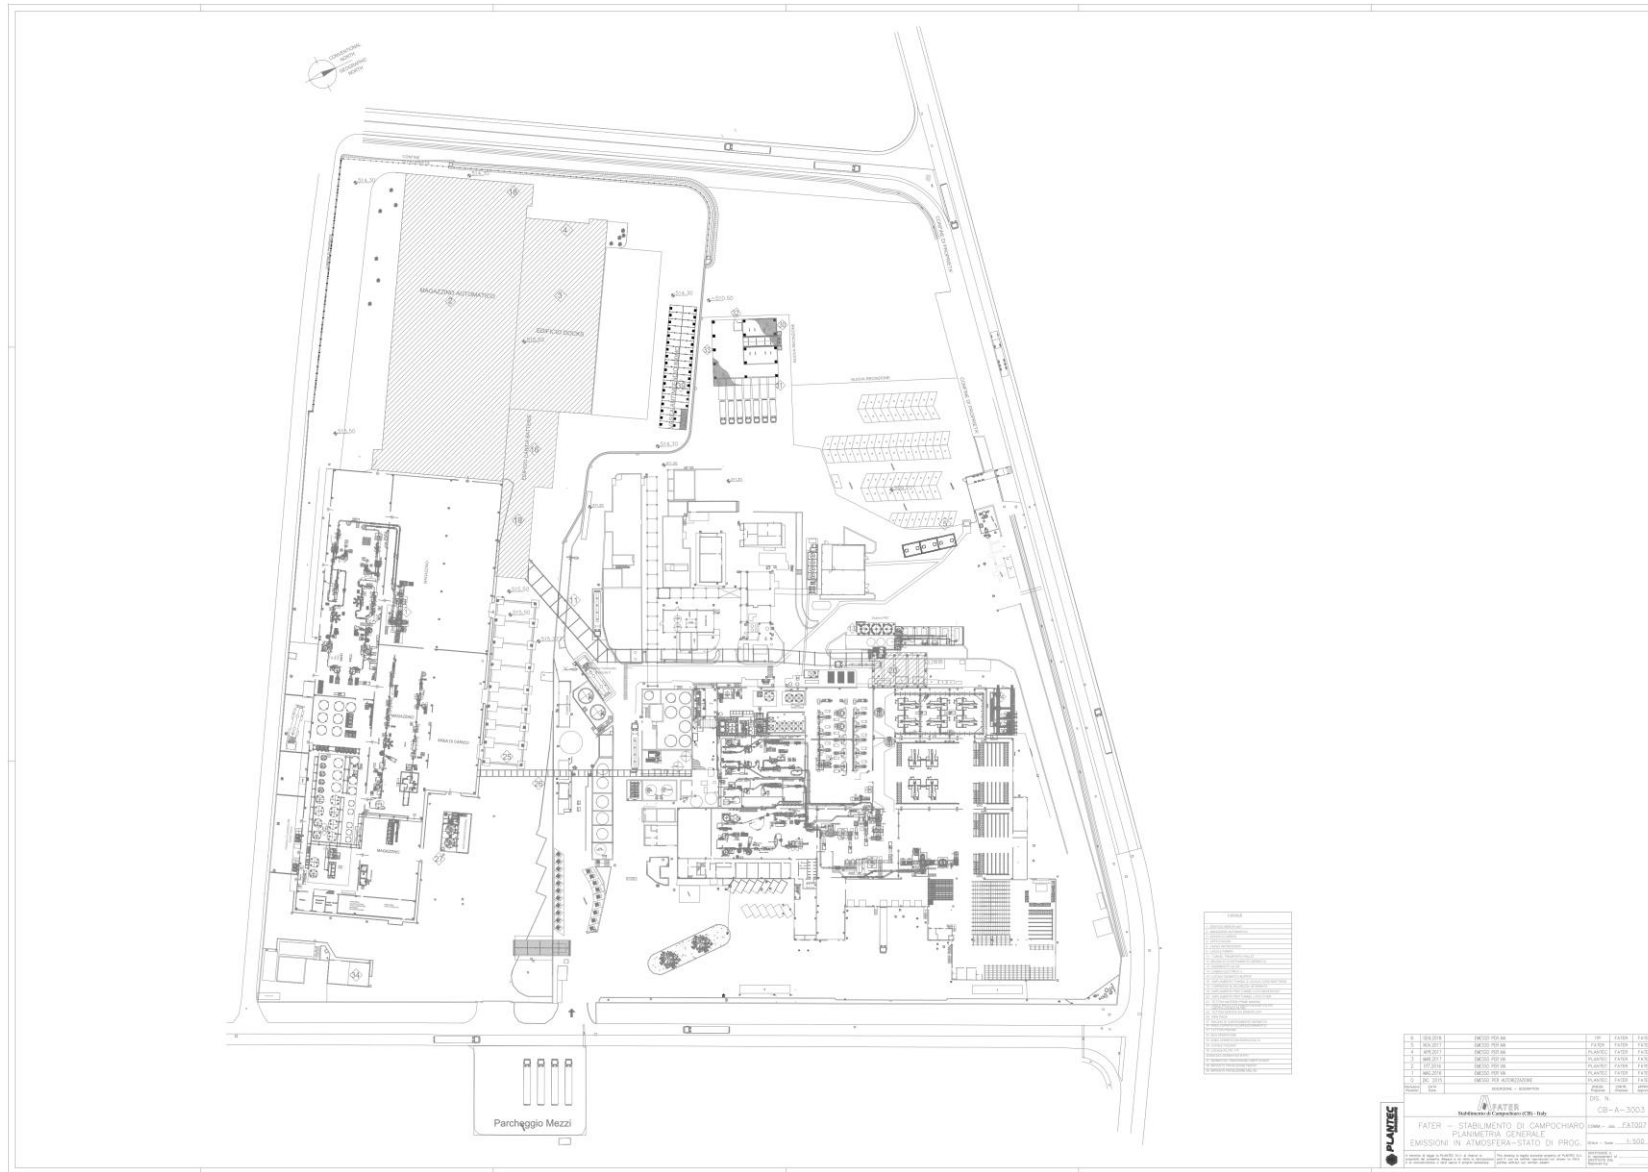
planimetria generale dell'installazione: assetto autorizzato con D.D. della Regione MOLISE n. 3298 dell'08/062021
